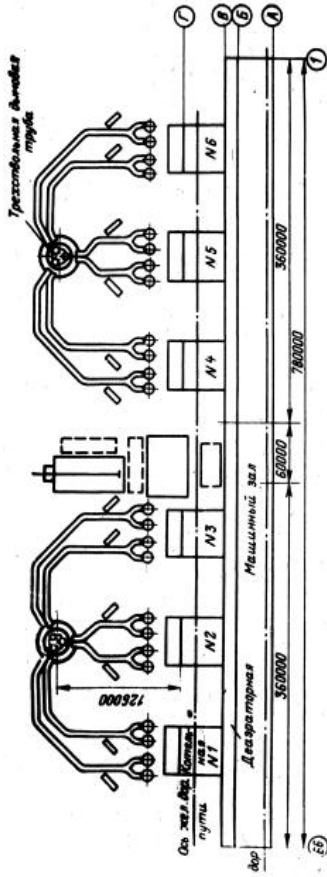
Главный корпус газомазутной ГРЭС-2400 с блоками 800 МВт:
